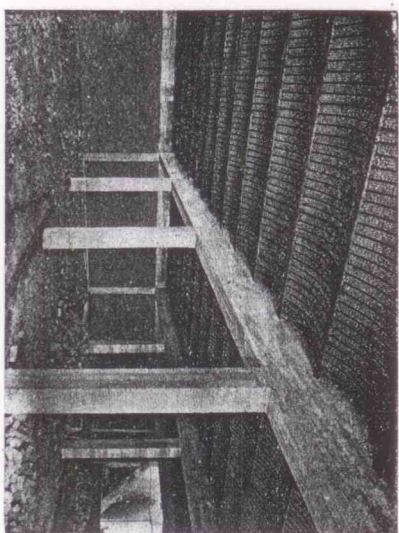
Uma laje construída com forma sobre vigas preparadas de ante-mão no solo.
